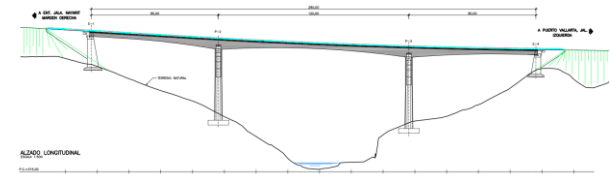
Alzado de la tipología con tablero ejecutado por avance en voladizo.
